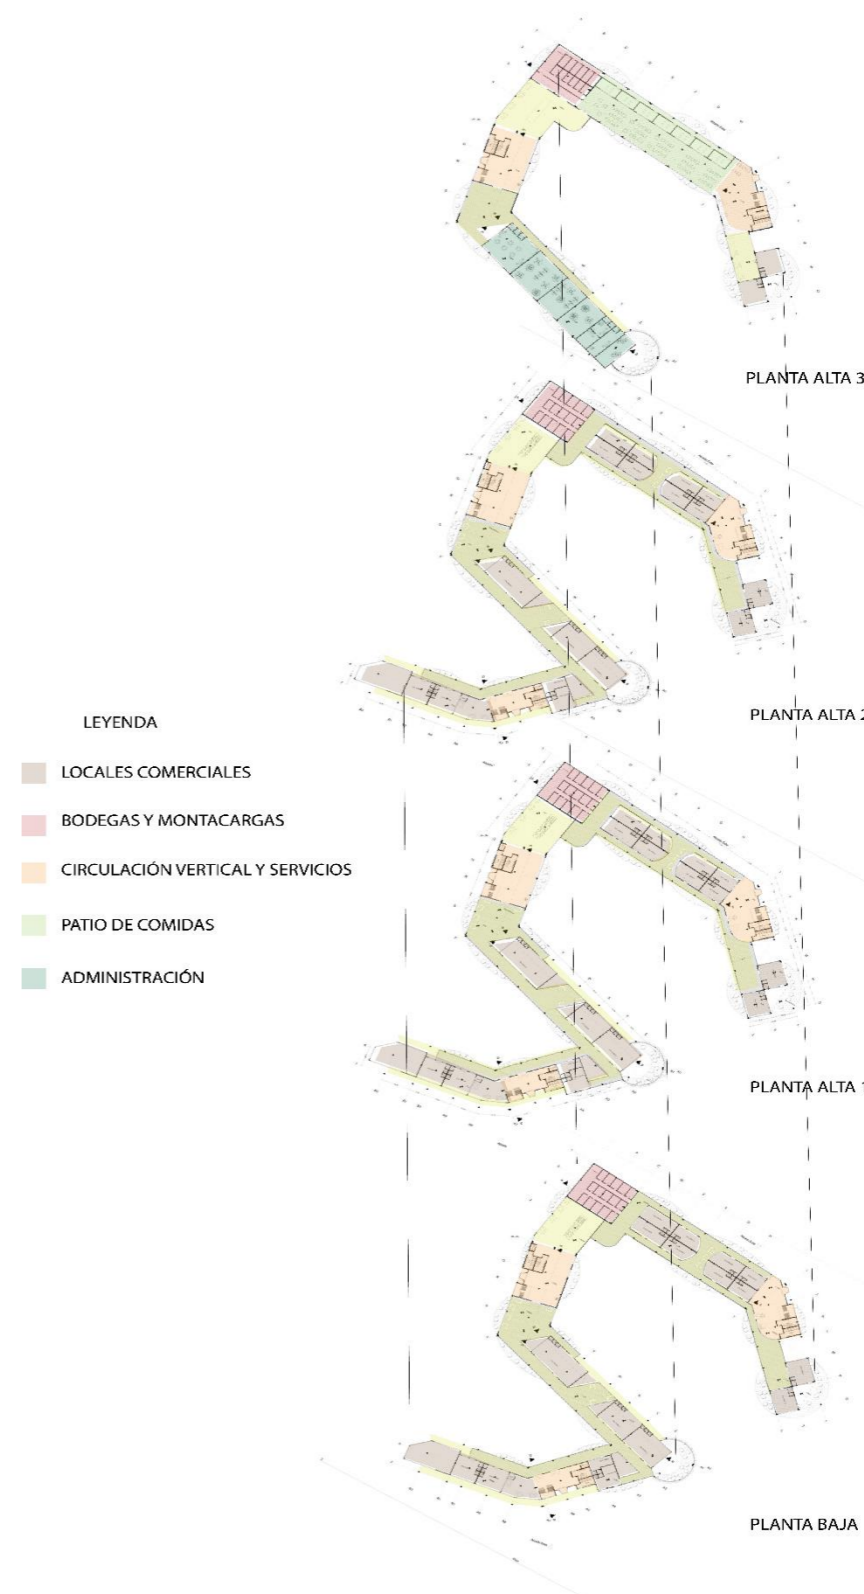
DISTRIBUCIÓN DE LA PLANTA BAJA DEL EQUIPAMIENTO COMERCIAL
